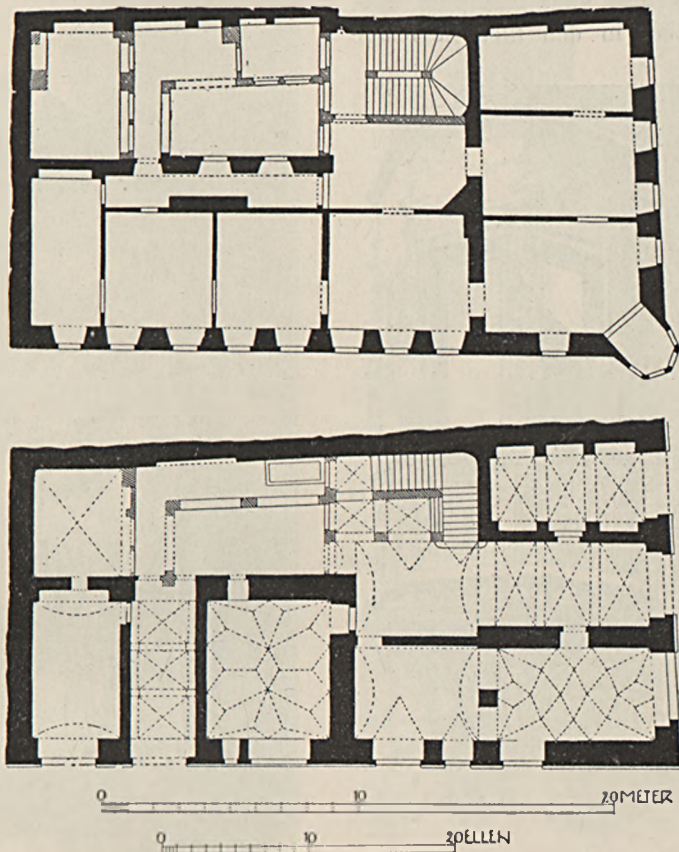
und 479. Wilsdrufferstrasse Nr. 2. Grundriss des Erd- und ersten Obergeschosses.
